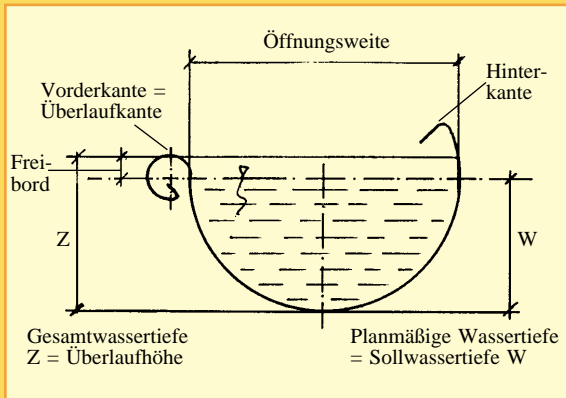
Begriffe und Bezeichnungen zum Dachrinnenquerschnitt
